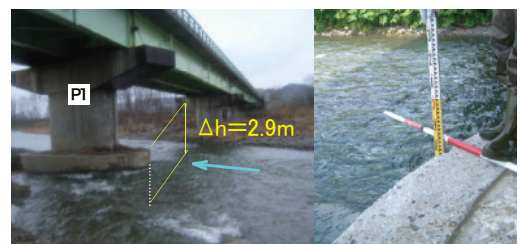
P1橋脚のケーソン基礎露出状況(2.9m)
